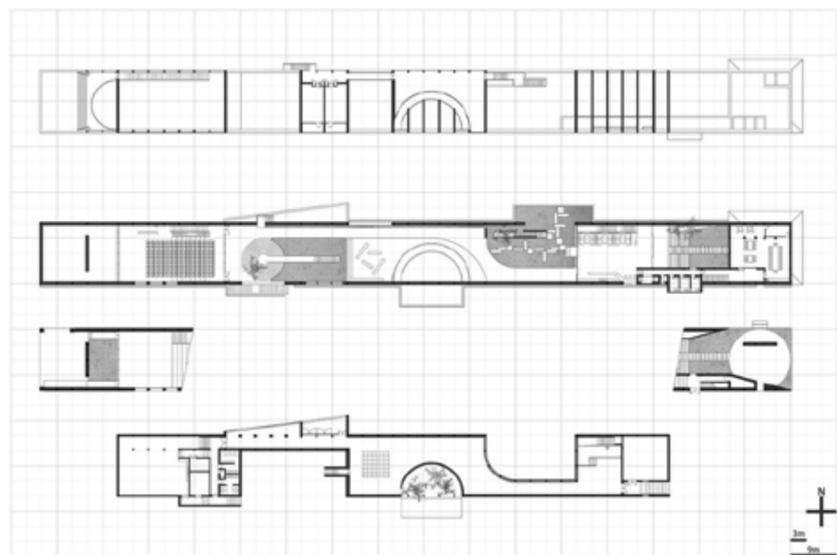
Plantas dos pavimentos do museu: térreo, primeiro pavimento e cobertura, respectivamente. Fonte: Archdaily<sup>23</sup>.
